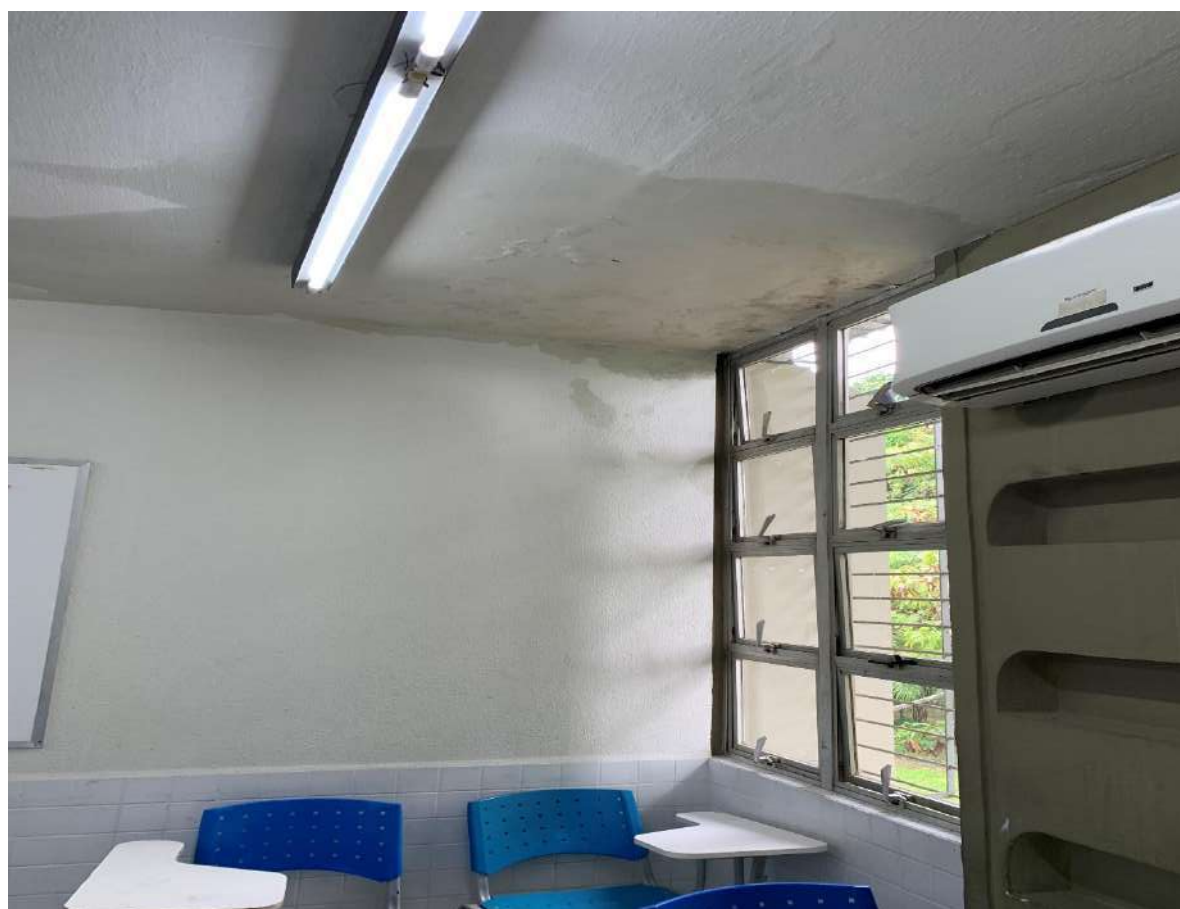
Infiltração em teto de sala de aula 2° pavimento CAp
